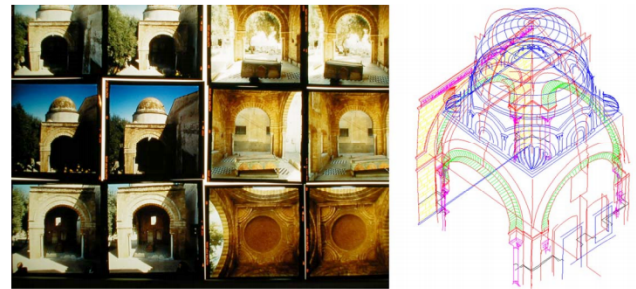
Levantamiento arquitectónico de cúpula bizantina, levantamiento arquitectónico, Almagro Gorbea, Antonio
